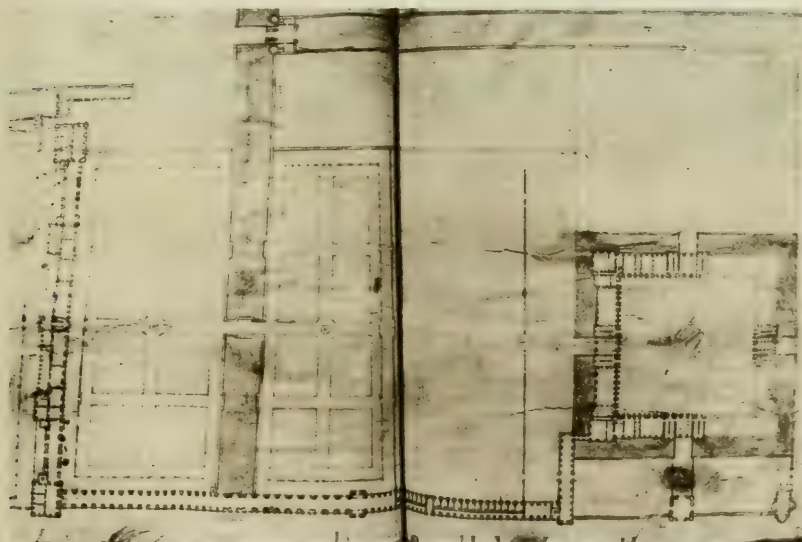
Plan d'agrandissement de 1598.* — Collection Destailleur.
